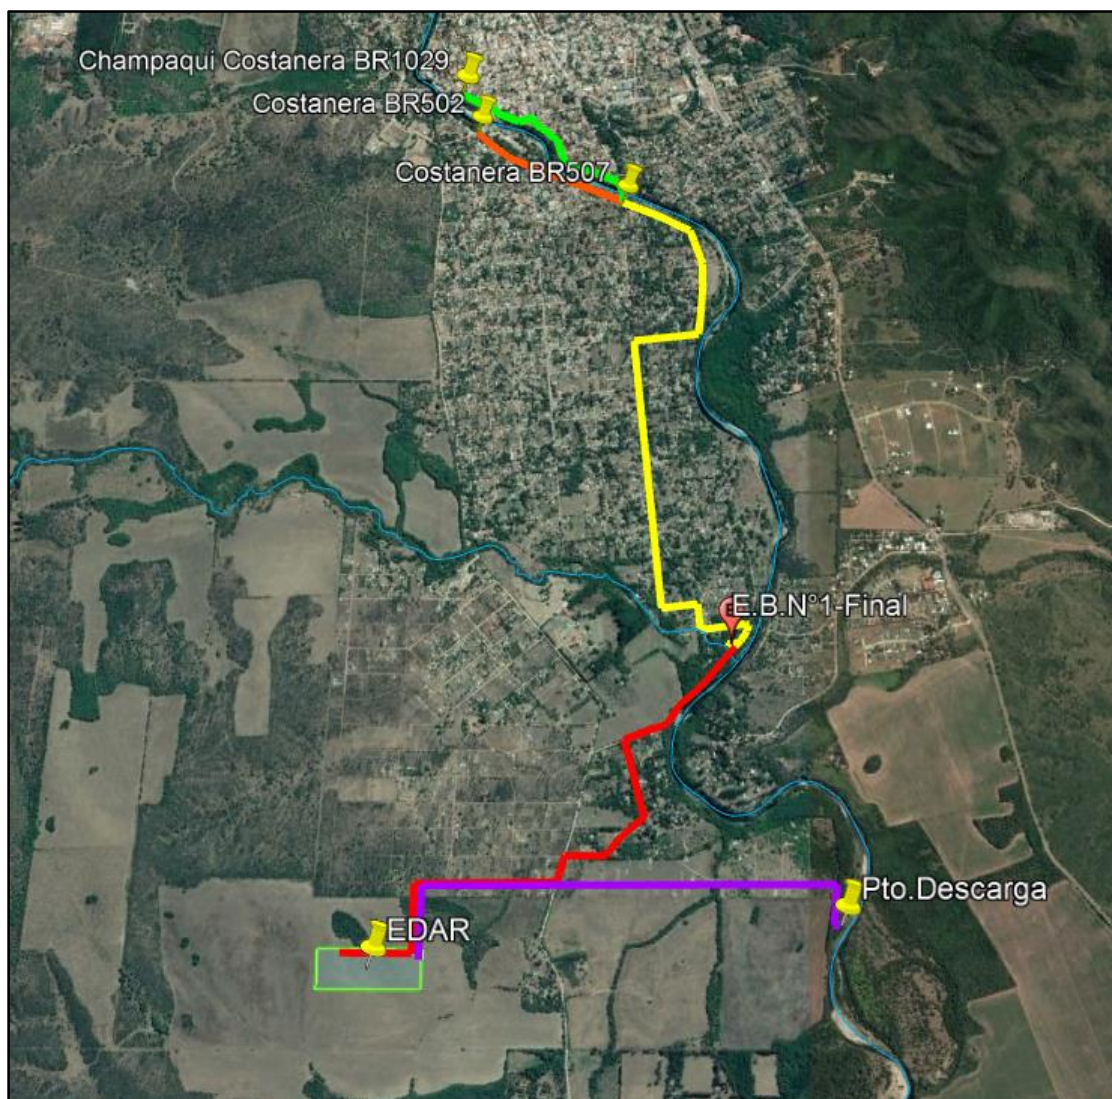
PLANIMETRÍA DE OBRAS A EJECUTAR.
